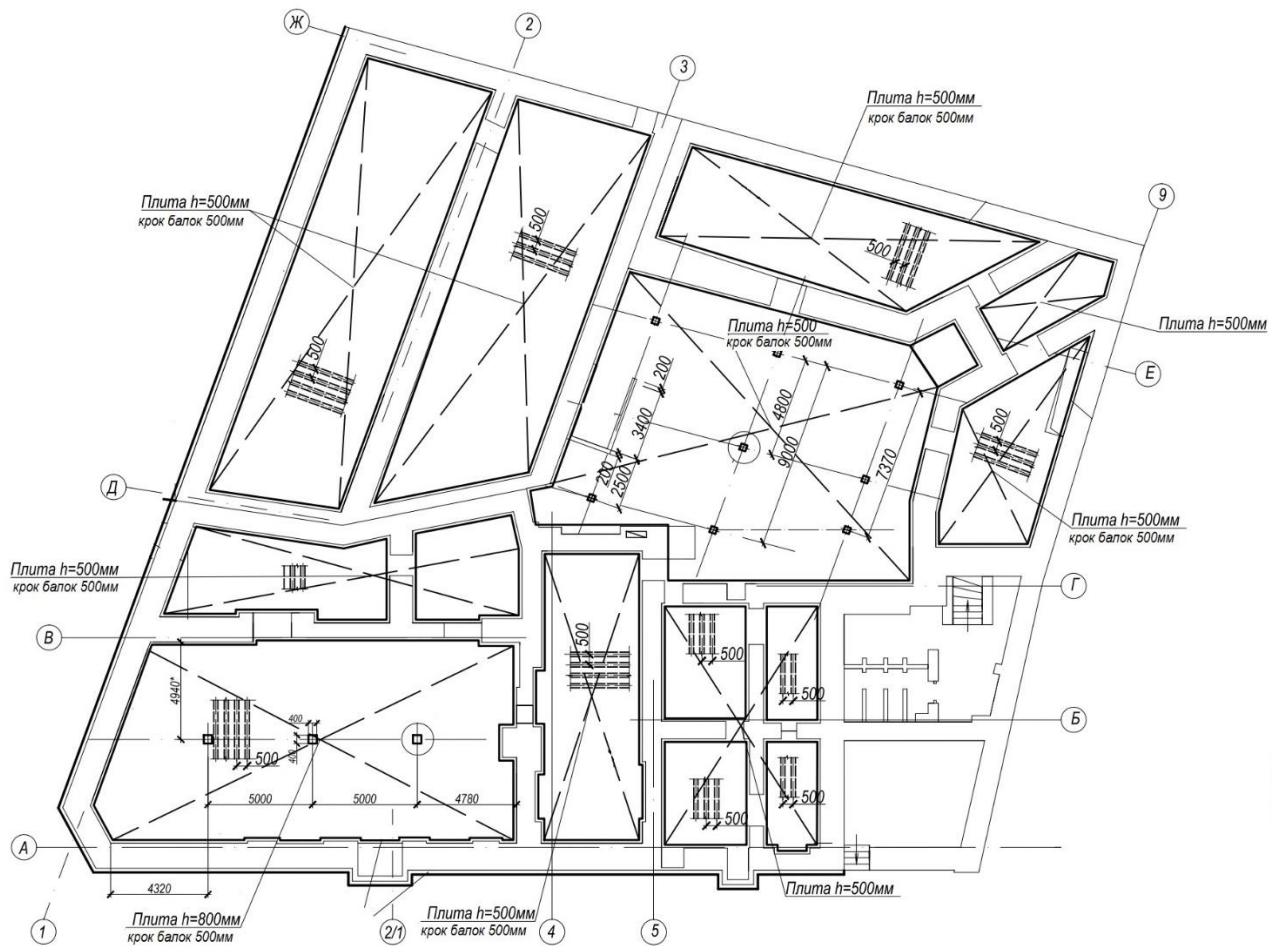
Схема влаштування монолітної фундаментної плити будівлі
